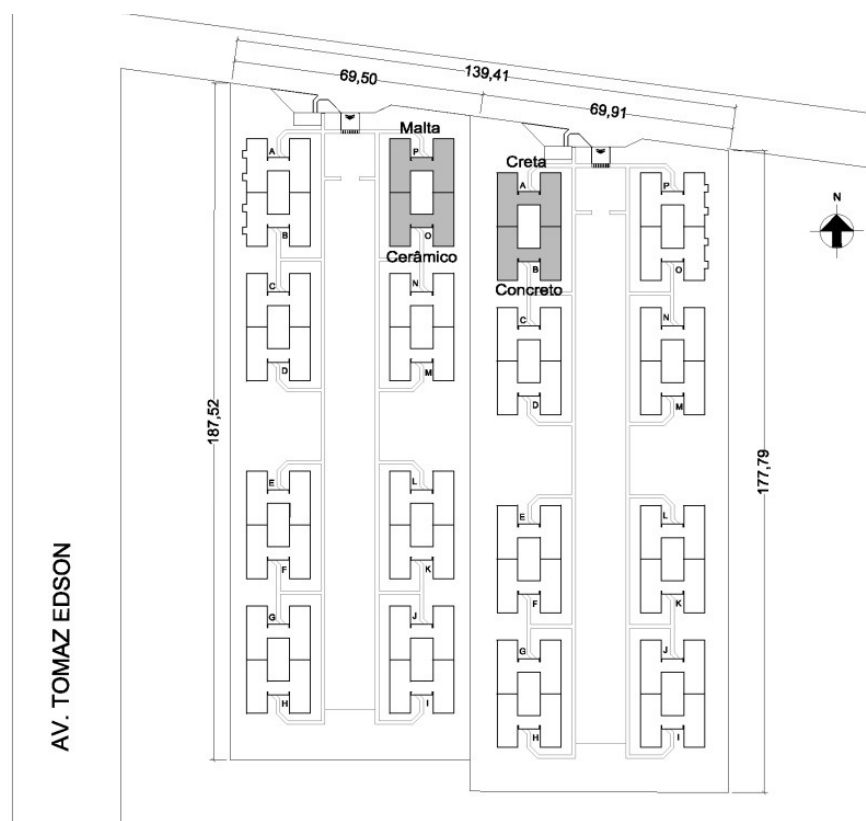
Planta baixa do condomínio com os residenciais Creta e Malta.
